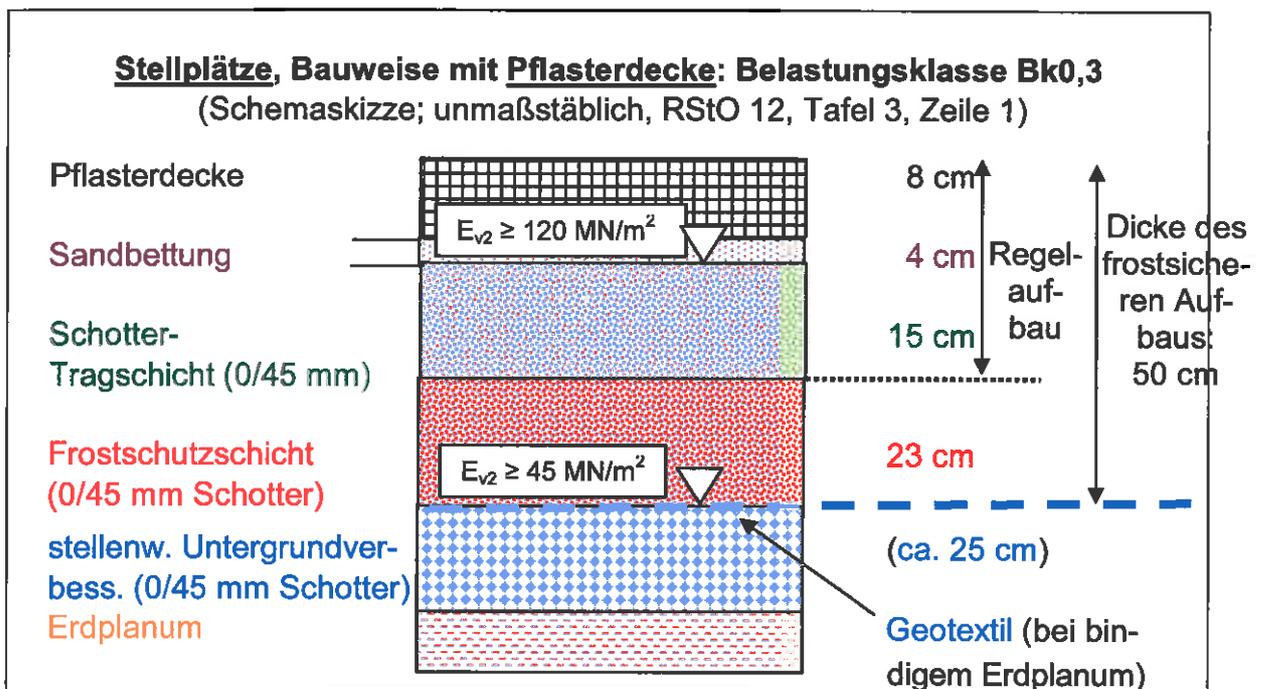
‚Aufbau‘ Pflasterdecke Außenanlagen
